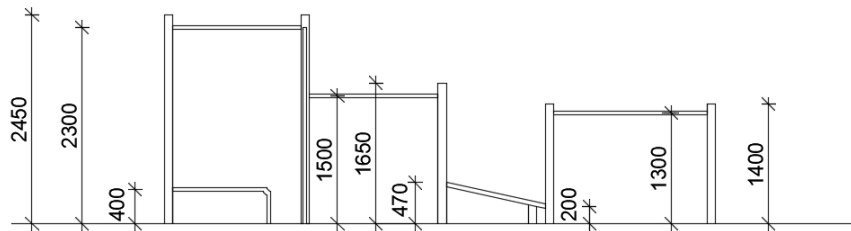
Pôdorys street workoutovej konštrukcie
